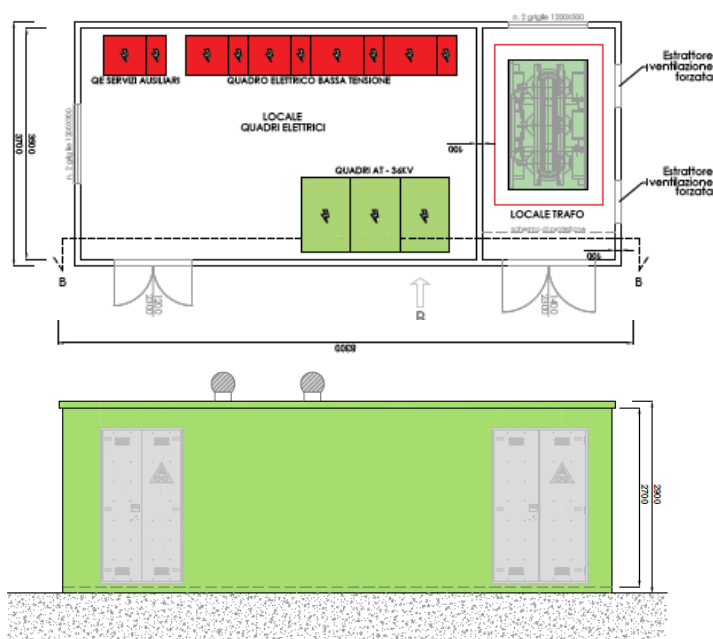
Pianta e Prospetto cabina di trasformazione
